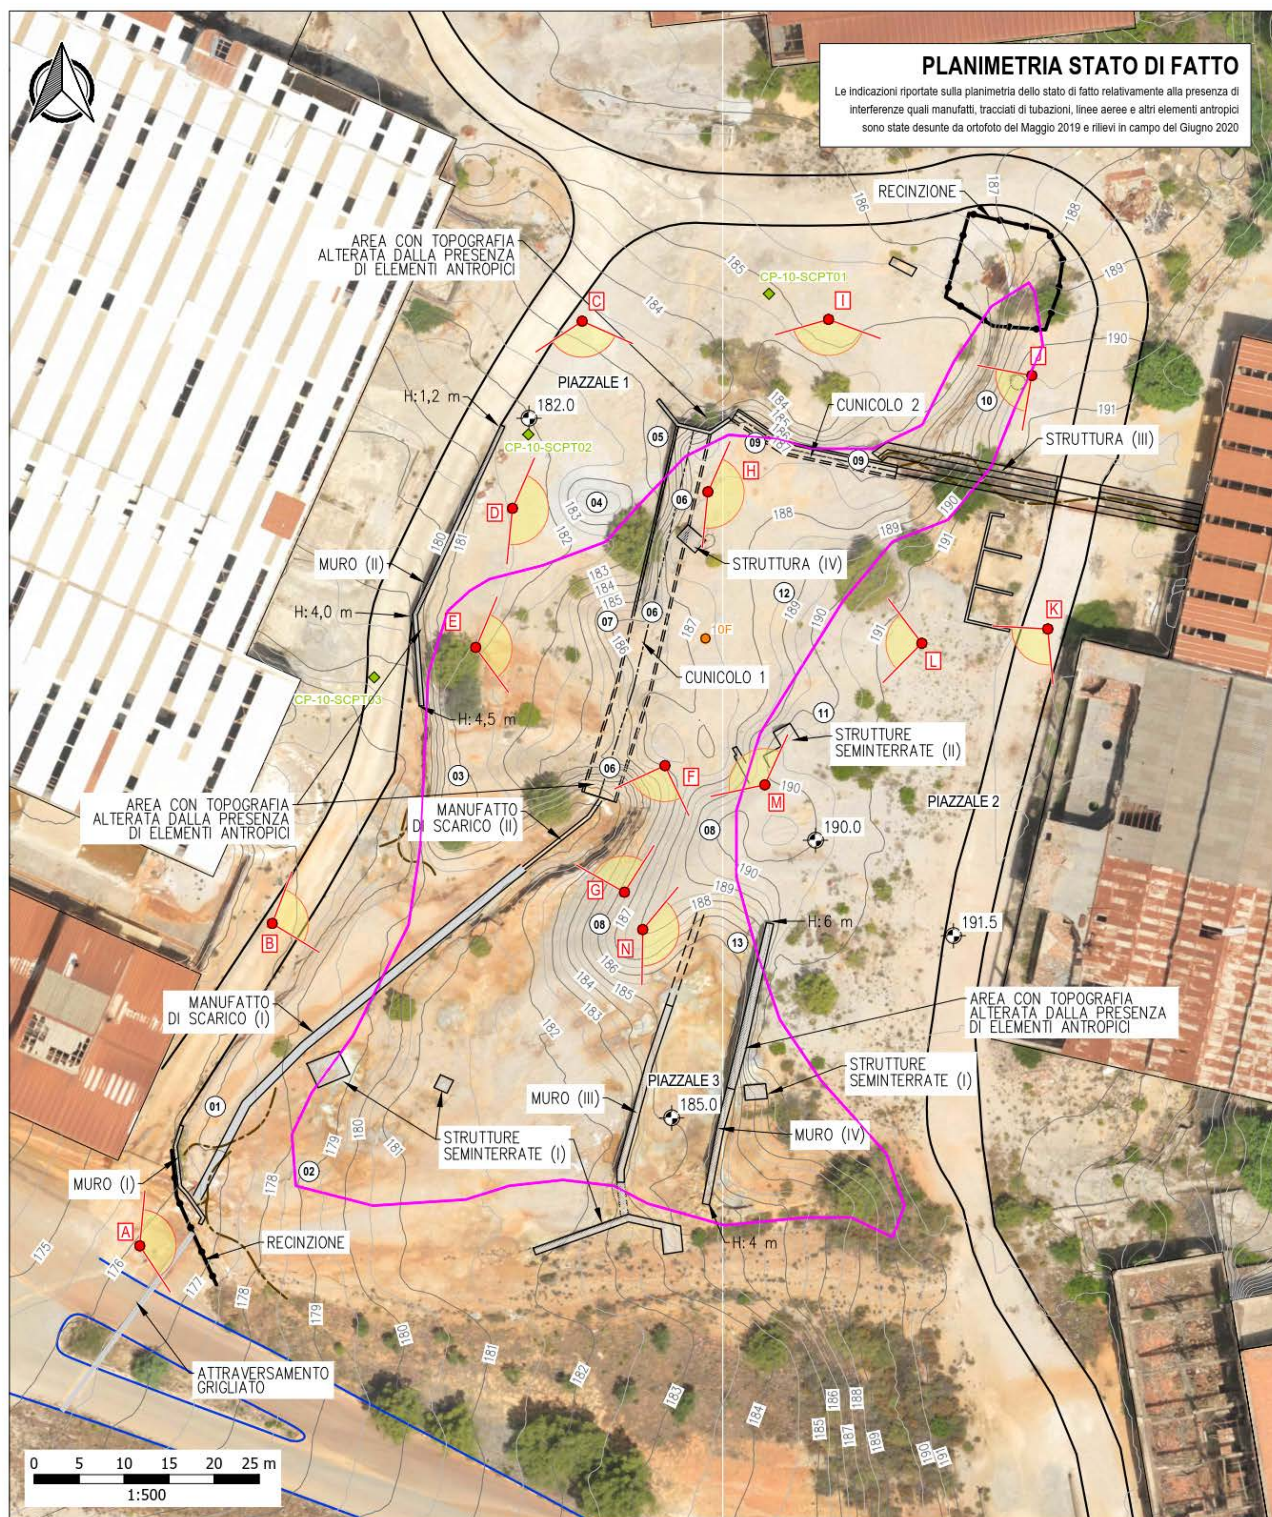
STRALCIO PLANIMETRIA STATO DI FATTO Cdp CP10
